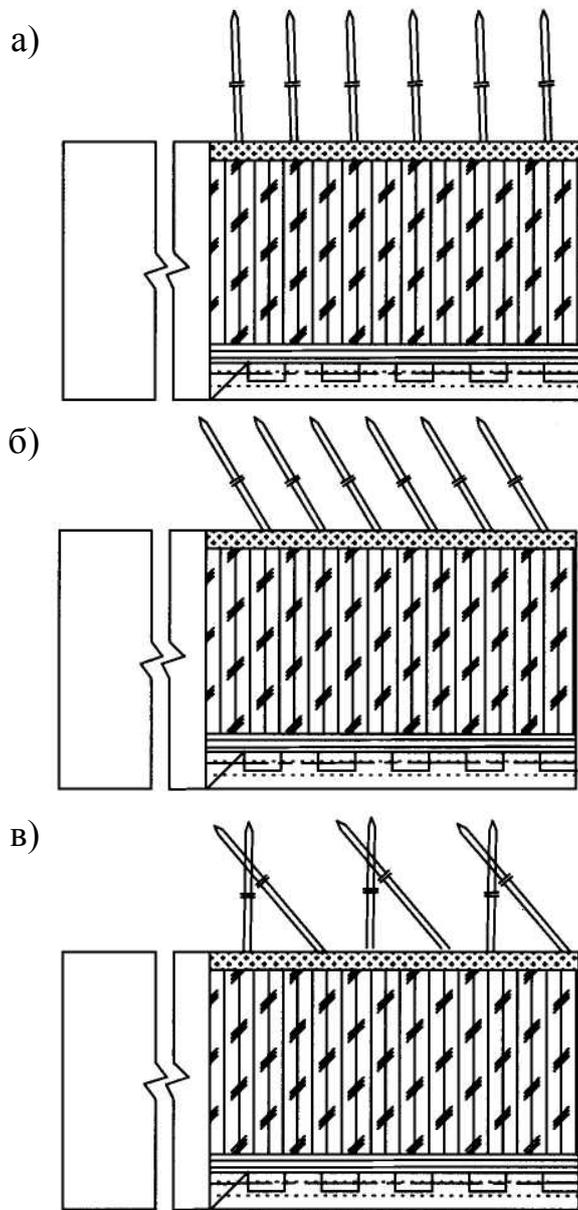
Схема расположения анкеров: а – вертикально к кровли выработки; б – под углом 60° с наклоном в сторону забоя; в – комбинированное расположение
